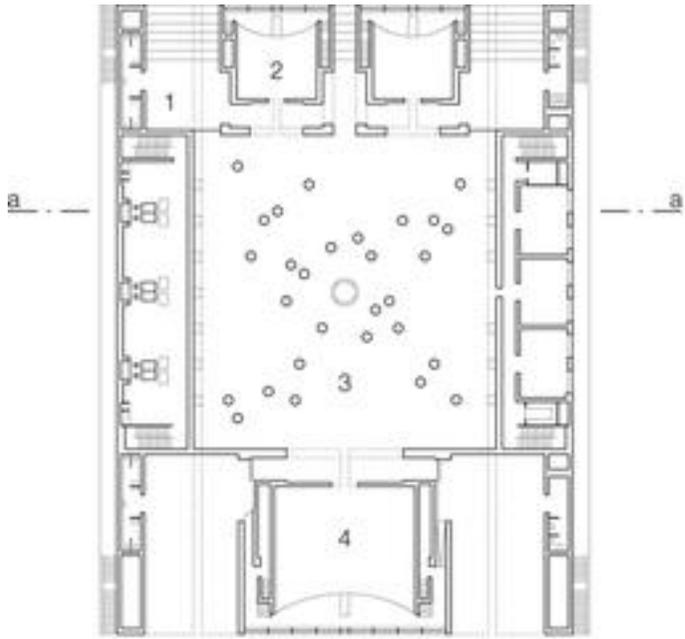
Grundriss Krematorium Kakamigahara
